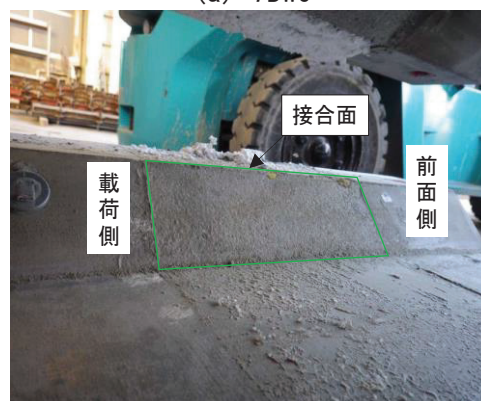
定着装置のひび割れ性状 (7BW0)
